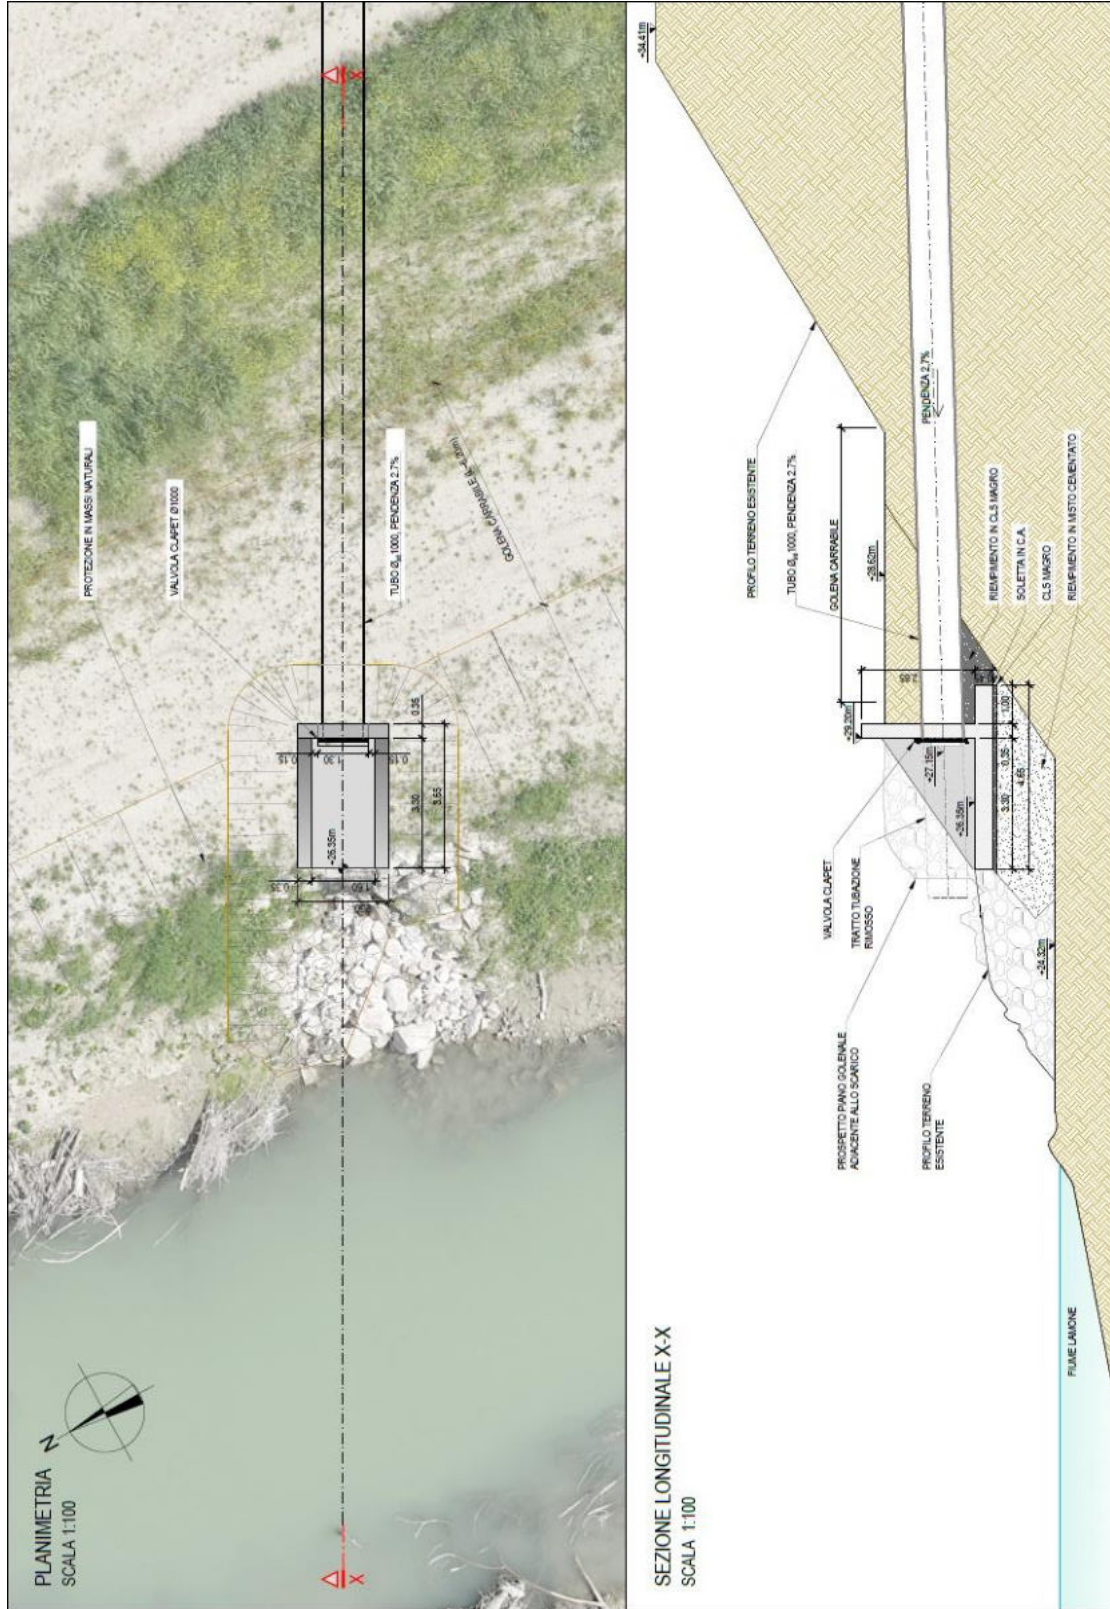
Pianta e sezione delle opere di protezione dello scarico n.27
